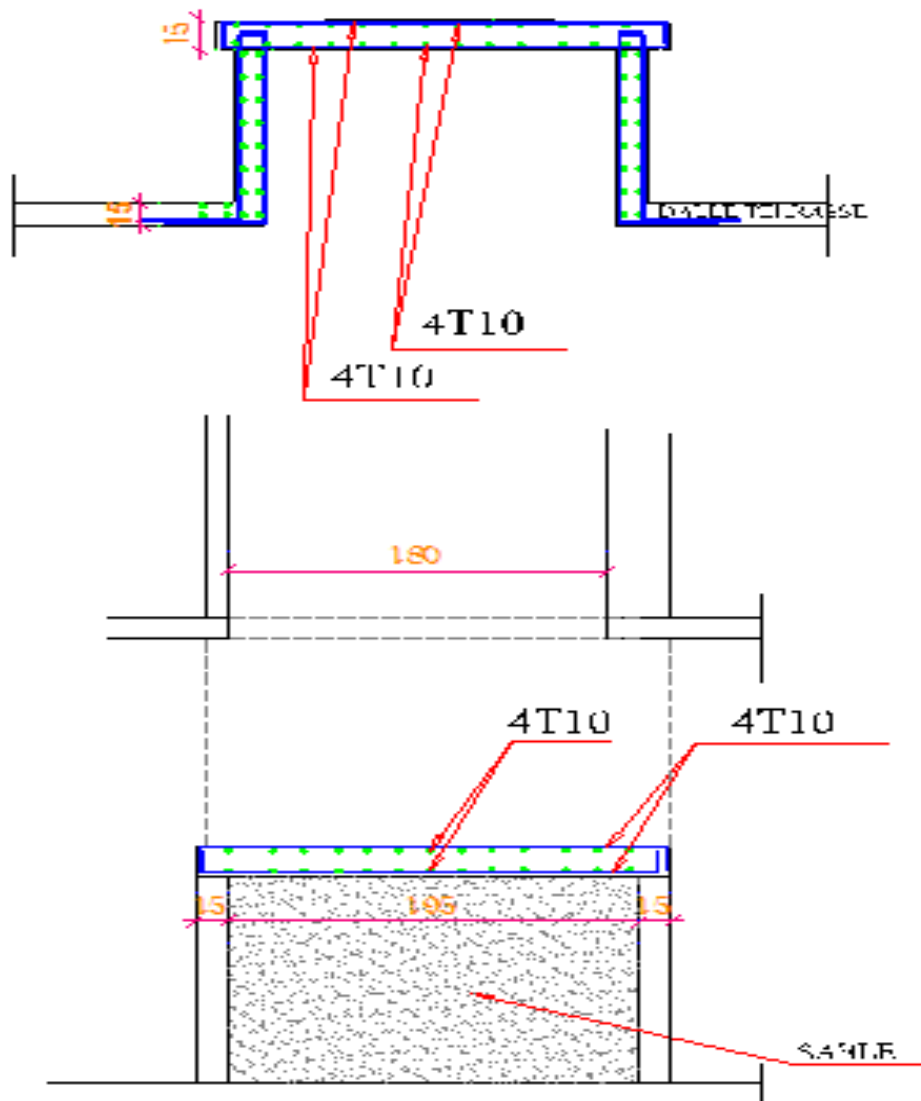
Coupe ferrailage de la dalle d'ascenseur.
